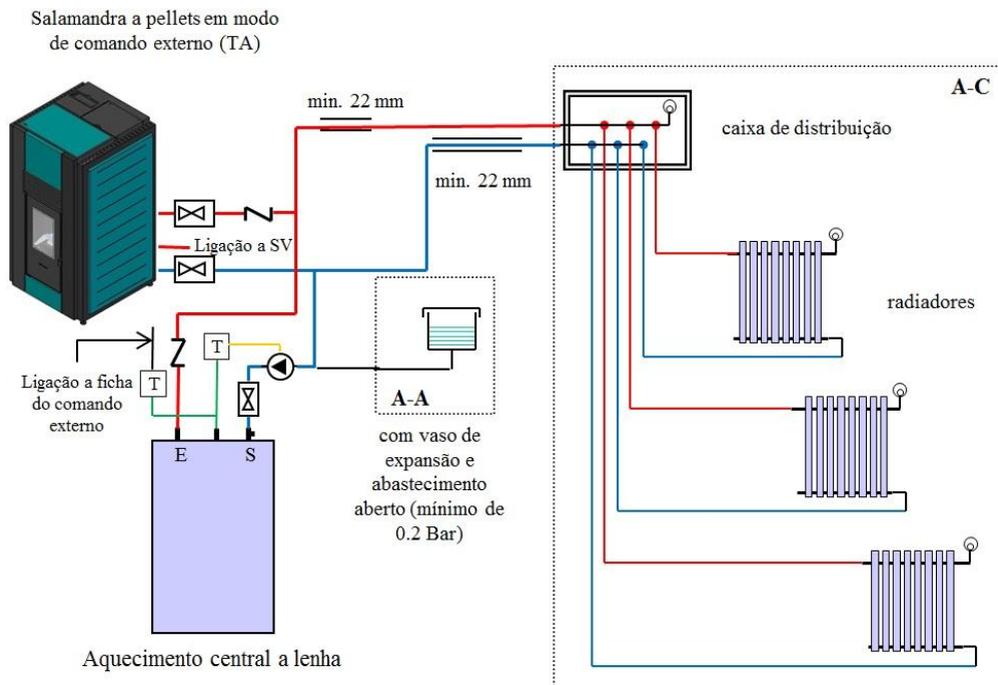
Esquema de instalação para aquecimento central com apoio a pellets
